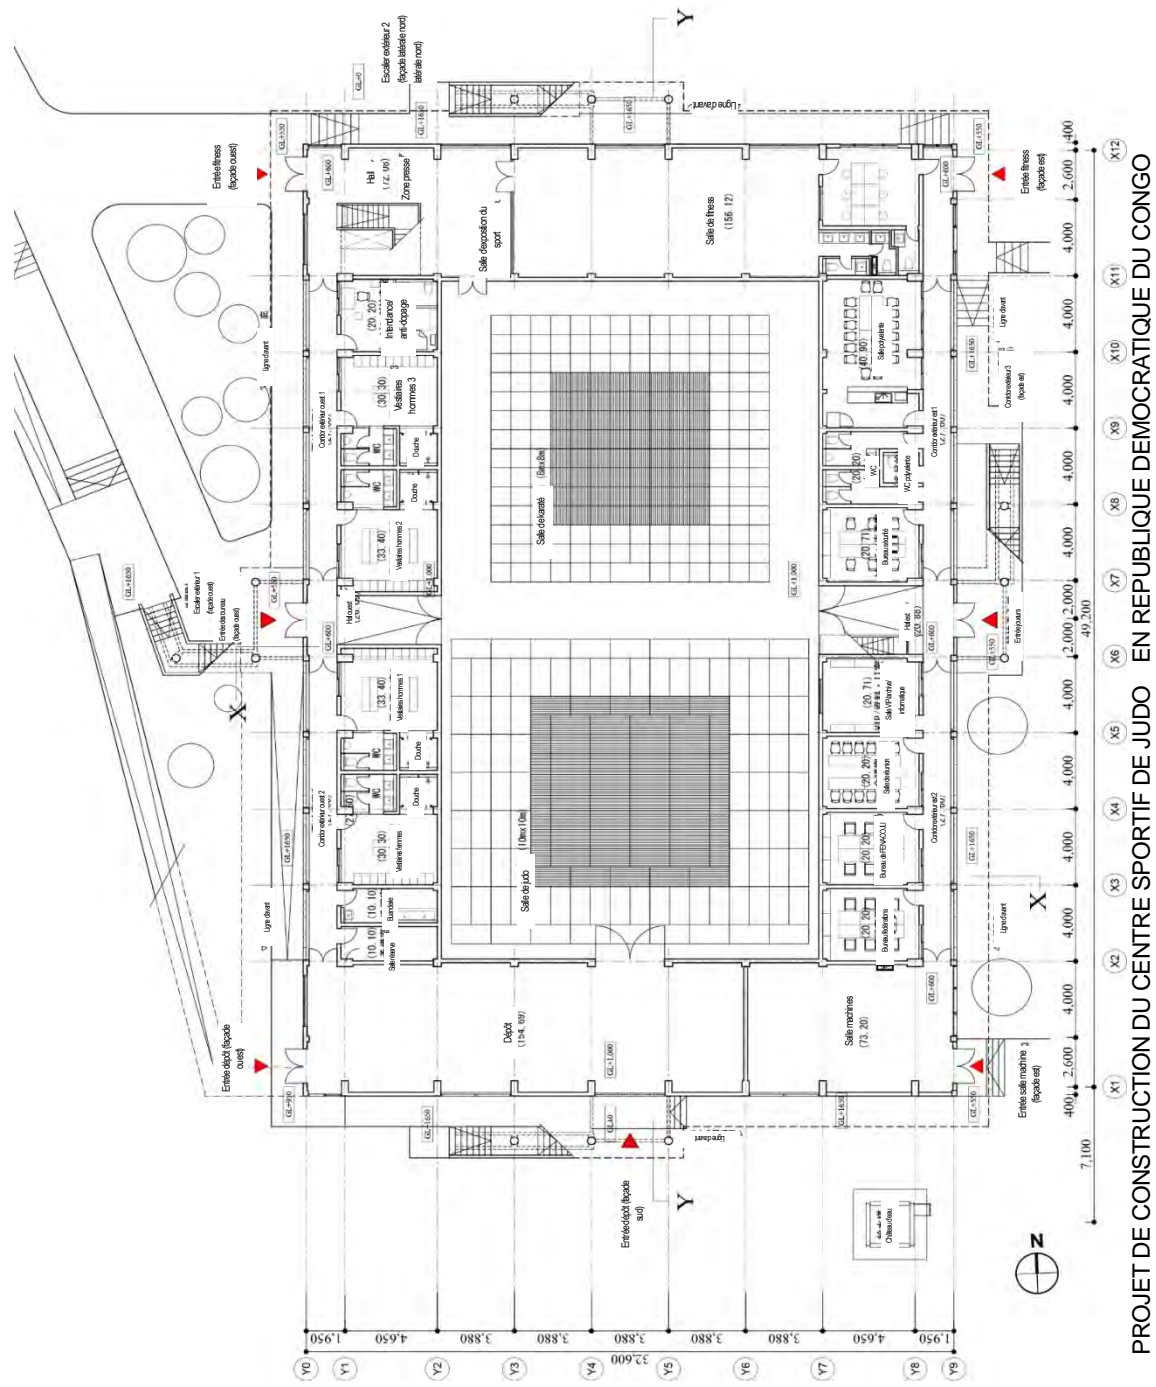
A-2 Vue en plan du rez-de-chaussée
